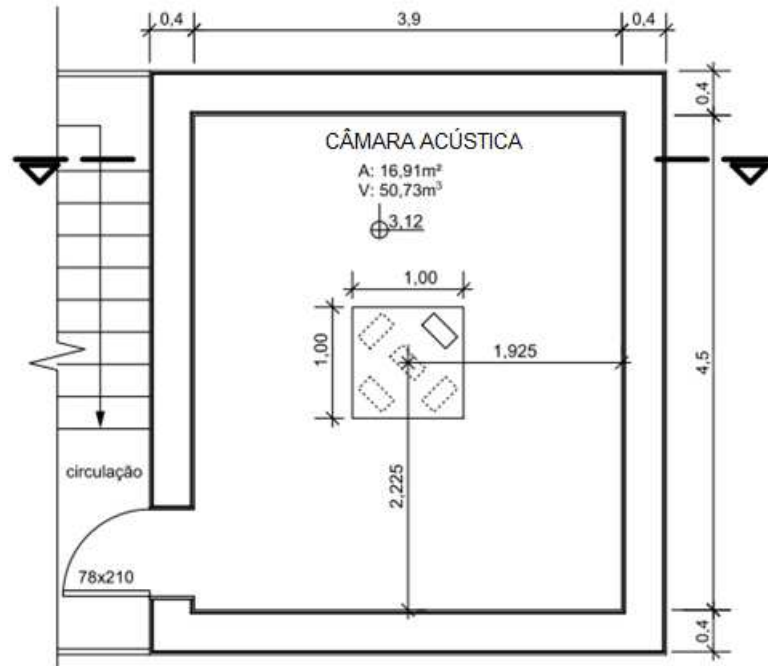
Planta baixa câmara acústica (sala emissora) - Esc: 1/50
